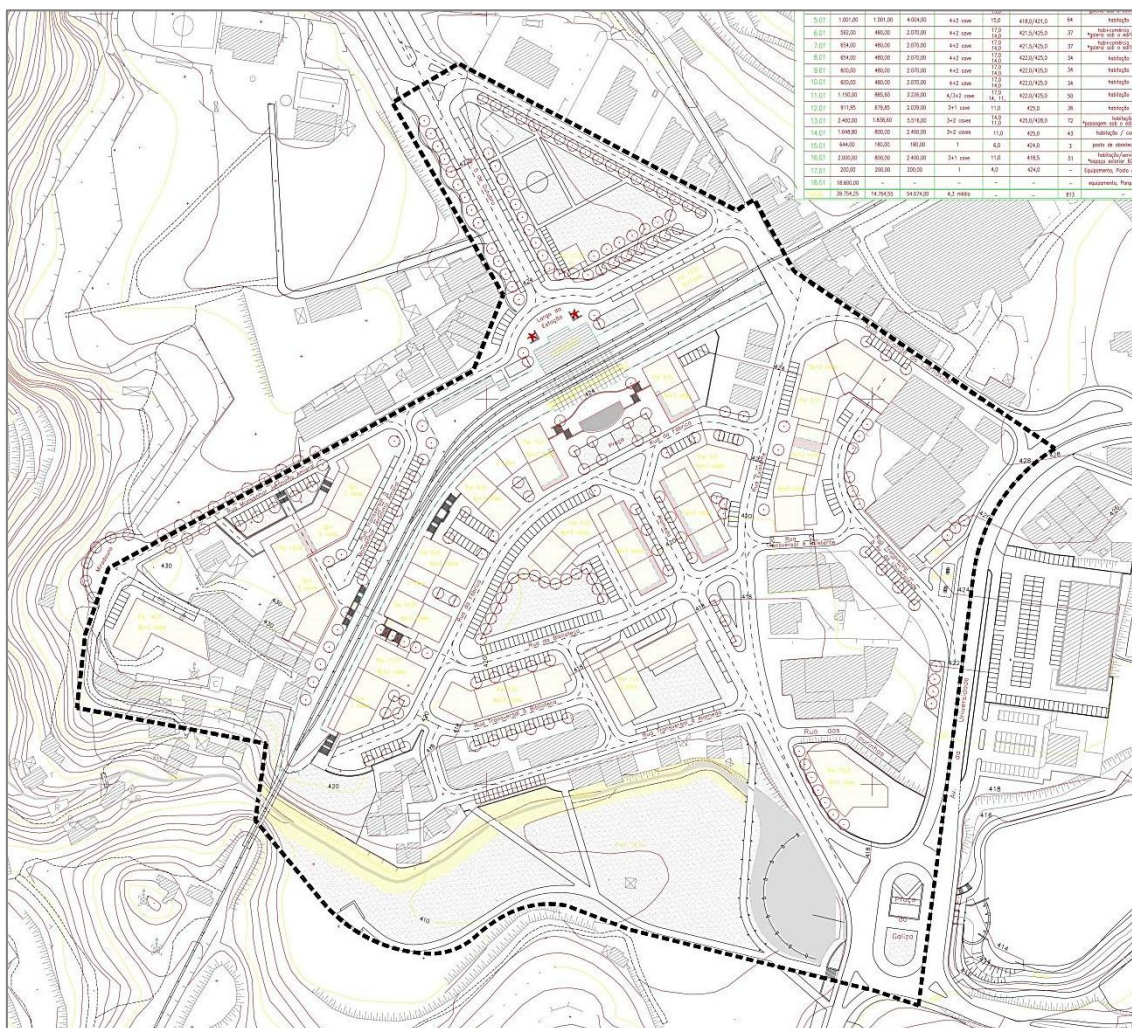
Extracto da Planta de Implantação do PPAZI e Legenda (2003)
